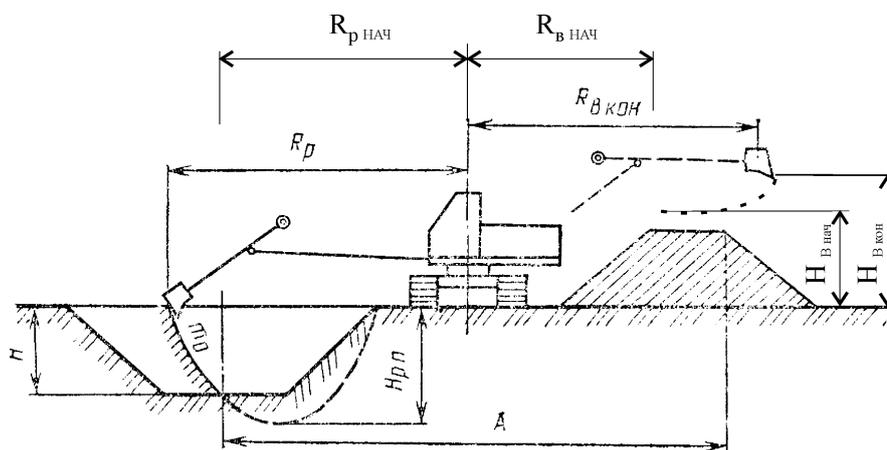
Разработка грунта лобовой или боковой проходкой
